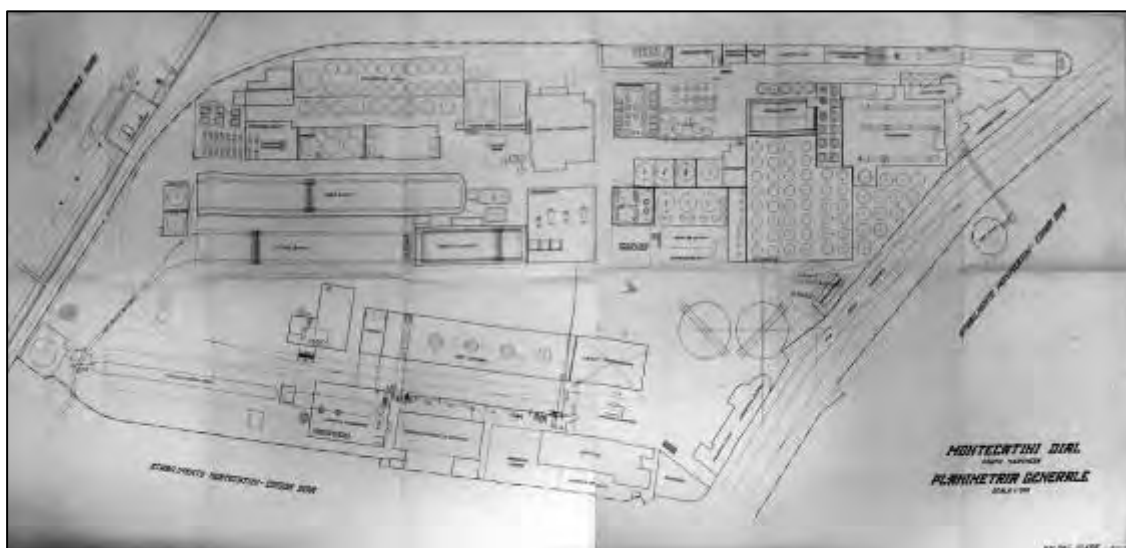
1961, planimetria dello stabilimento Montecatini Divisione Allumina 1942 (fonte: archivio Sacaim)
